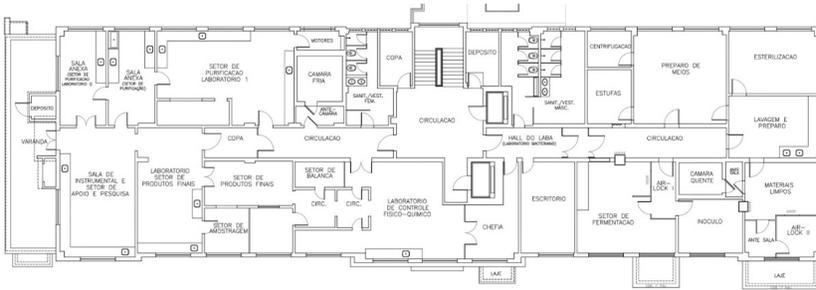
Planta baixa 2º pavimento - Pavilhão Rockefeller.
